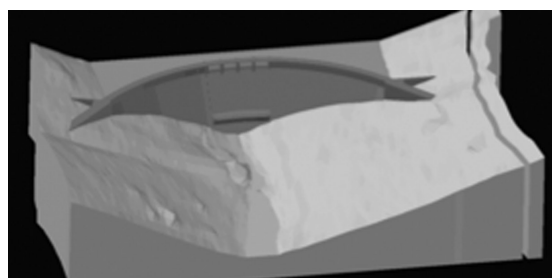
Vista 3D, presa de La Aceña, Ávila, España.
